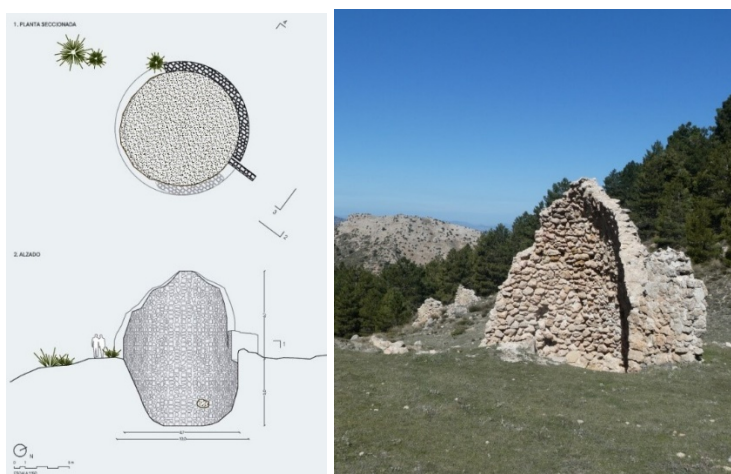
y 14. *Planta, alzado y fotografía de un pozo de Totana.
